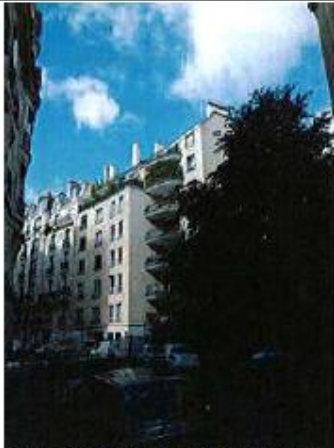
PHOTO DE L'IMMEUBLE AVANT TRAVAUX
